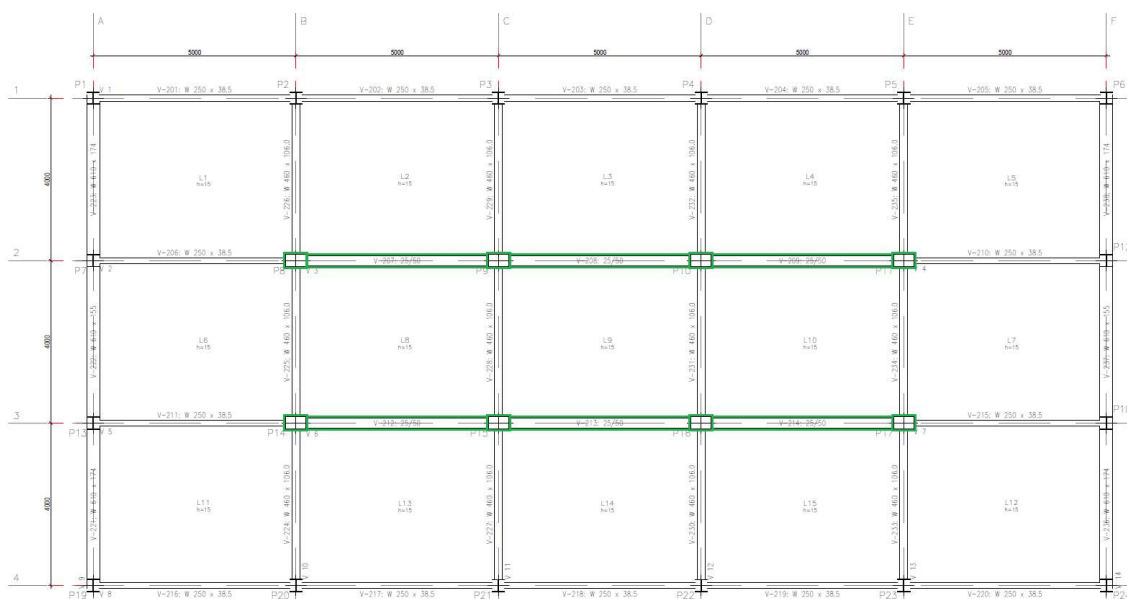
Vigas pavimentos 1 até 5 (estrutura associada 02)
